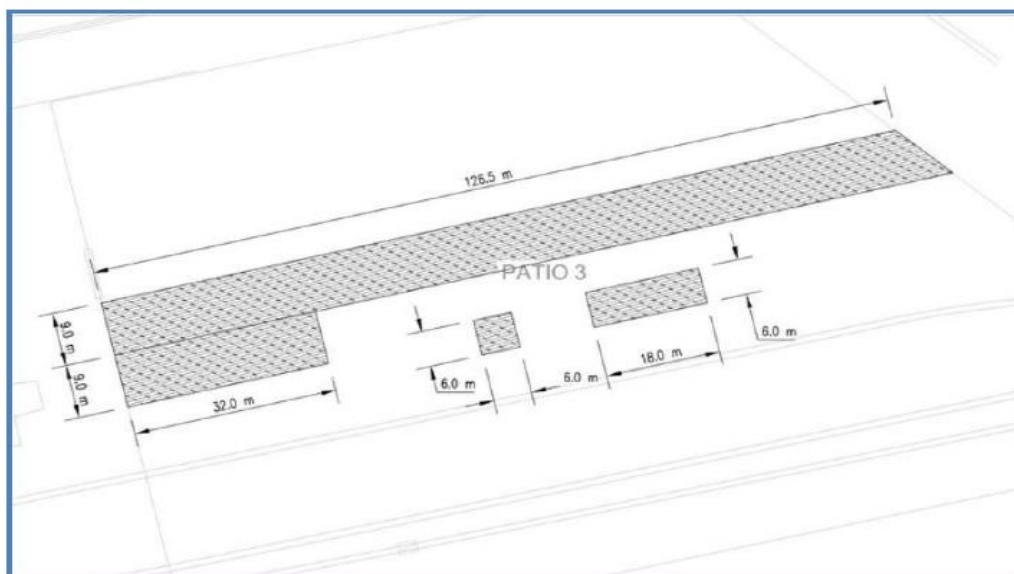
Dimensiones de los deterioros en el patio 3 Fuente informes Gestión de Plan de Mantenimiento 2016
